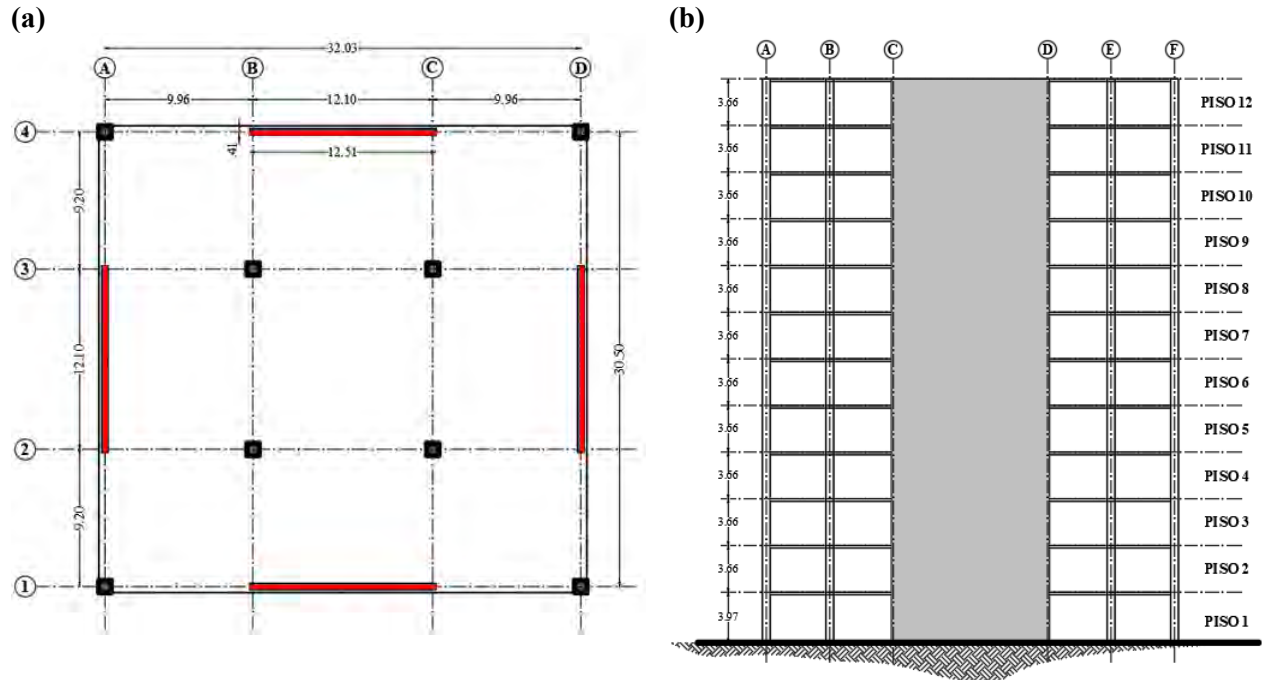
Planta y alzado de los arquetipos de 12 pisos (medidas en metros).
